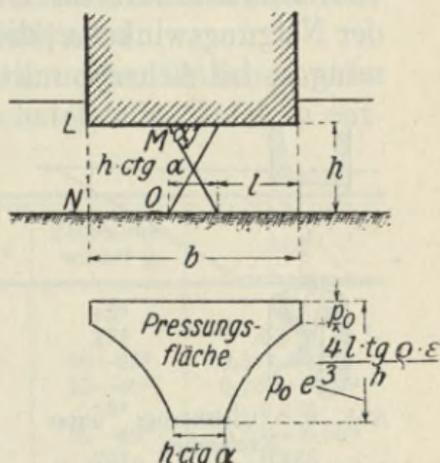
Pressung einer Sandschüttung von beschränkter Höhe.
